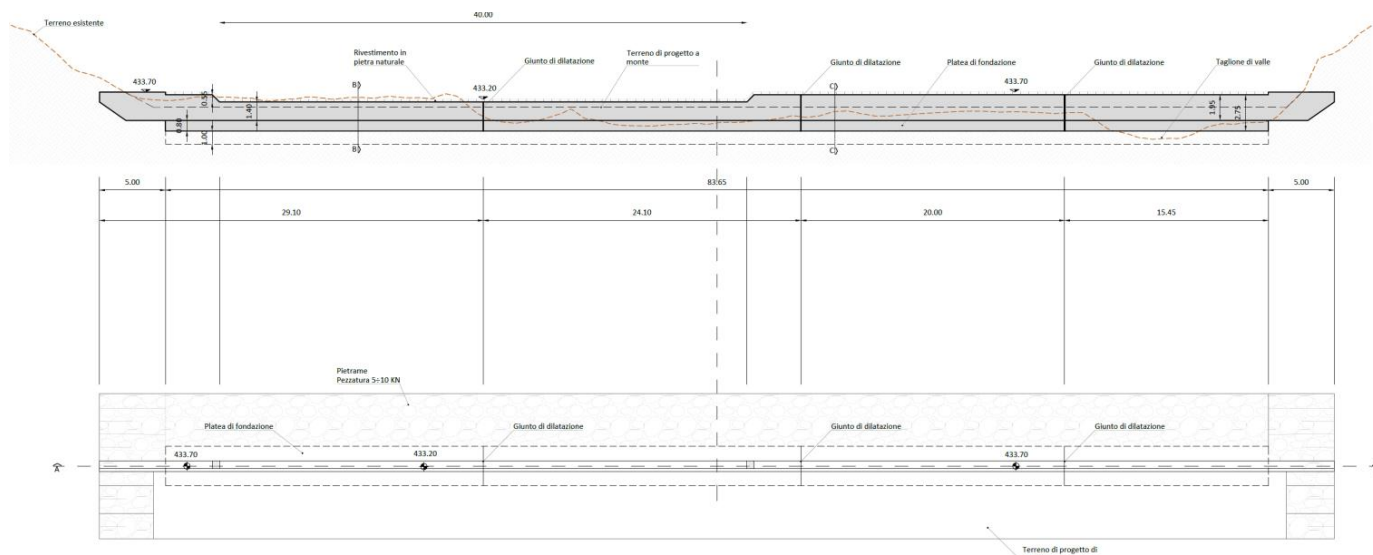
Esempio di briglia rettilinea: briglia di monte M_2. Prospetto (in alto) e planimetria (in basso).
